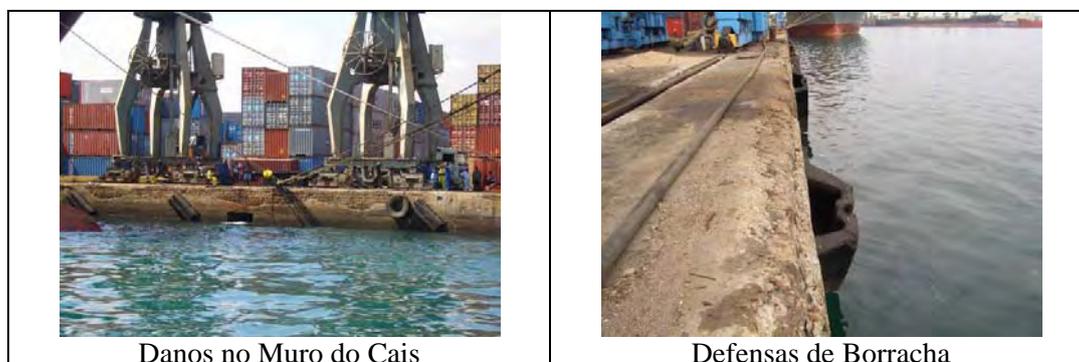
Condições do Muro do Cais e Defensas de Borracha
